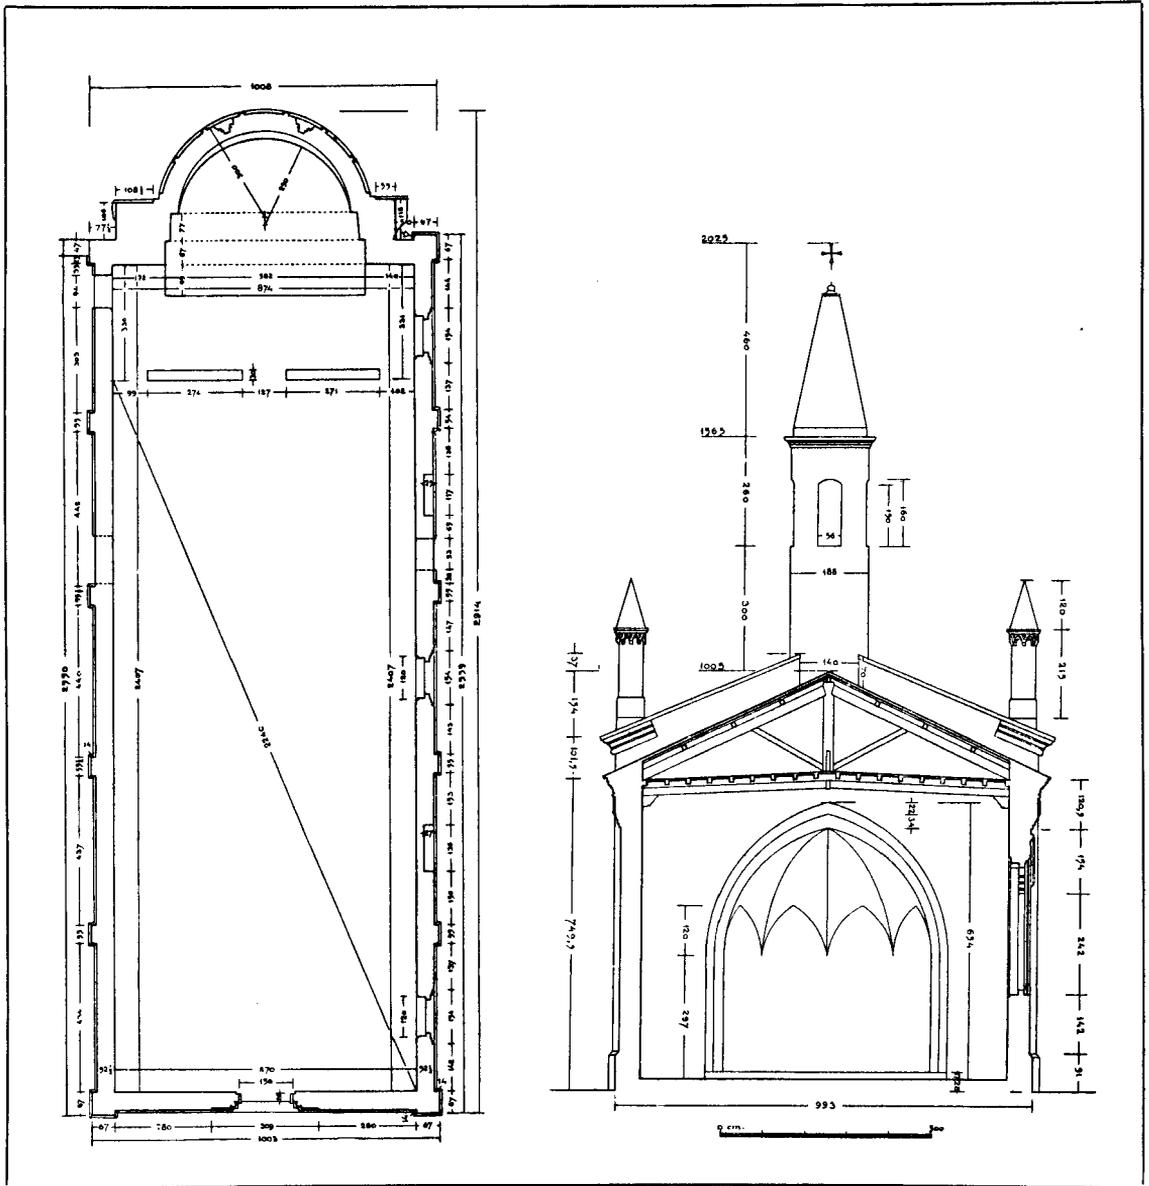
Oratorio di San Giacomo della Cerreta: pianta e sezione trasversale.
